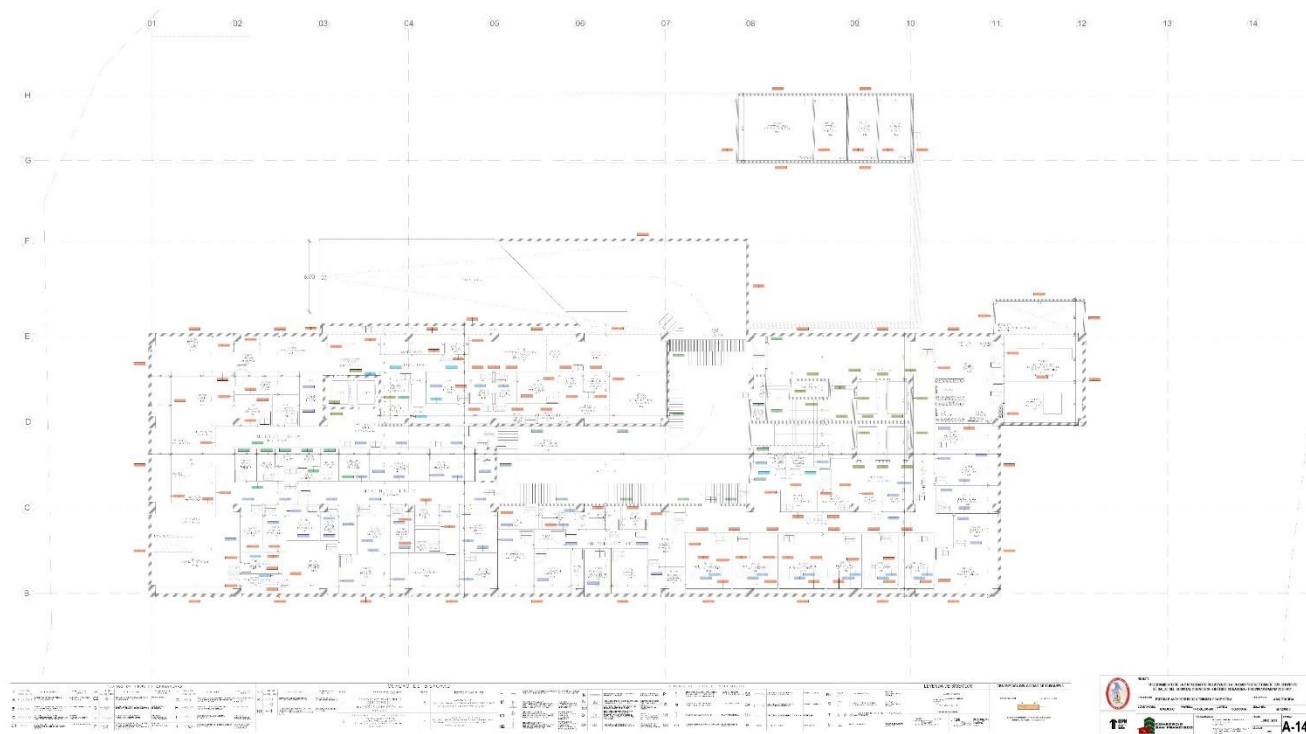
QUINTA PLANTA ZONIFICACION
